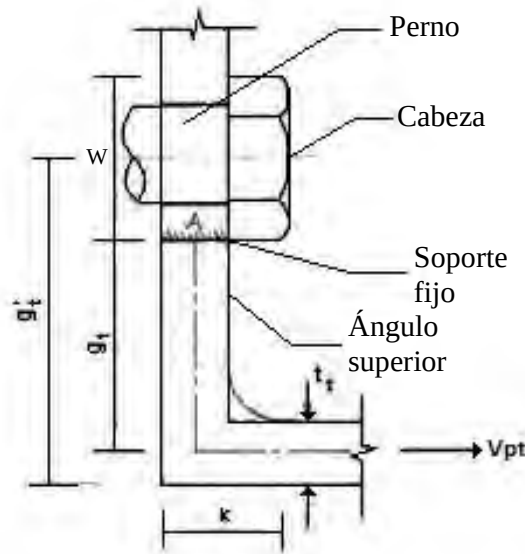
Ángulo superior conectado al ala de una columna (Kim & Chen, 1996)
